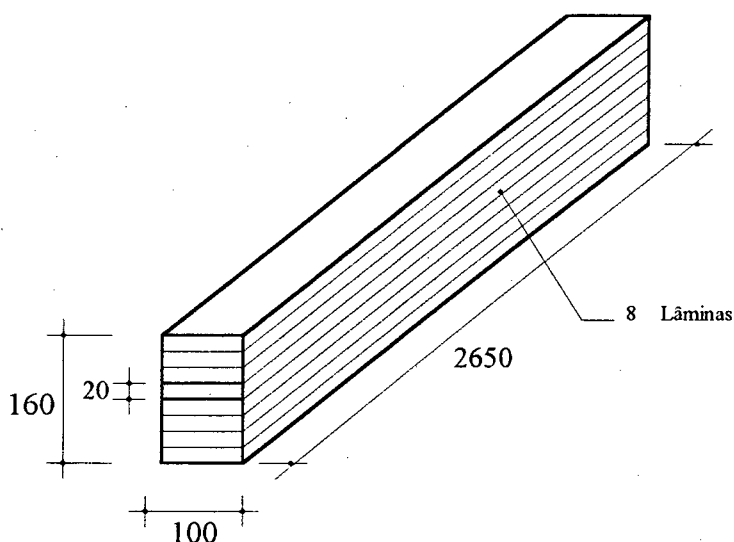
Dimensões geométricas das vigas (mm)
